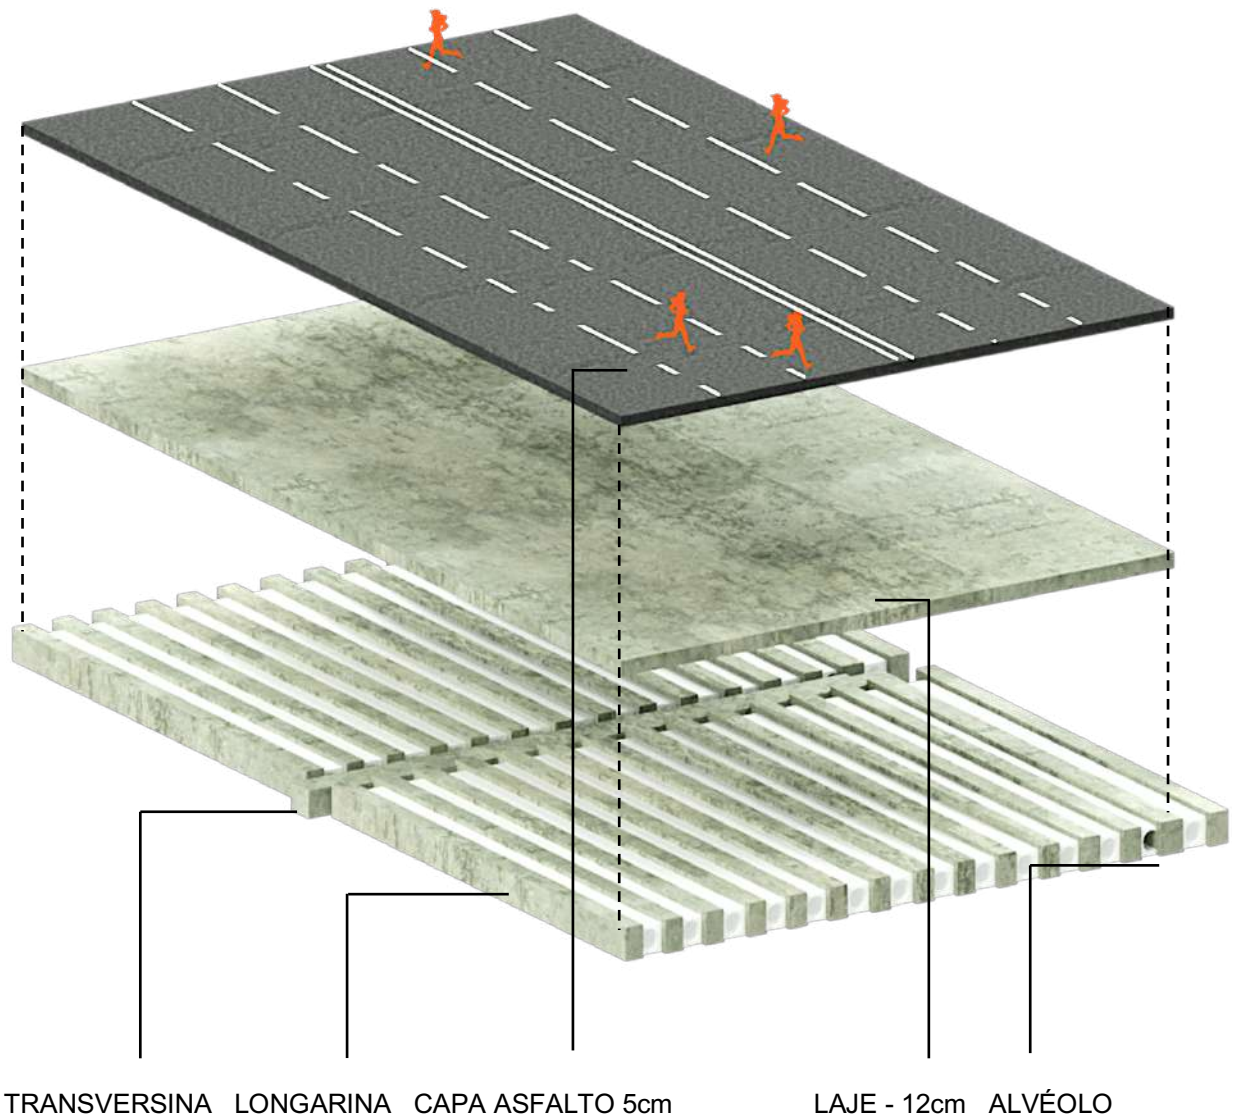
Esquema estrutural 3D da nova laje do Viaduto. Fonte: autoral
